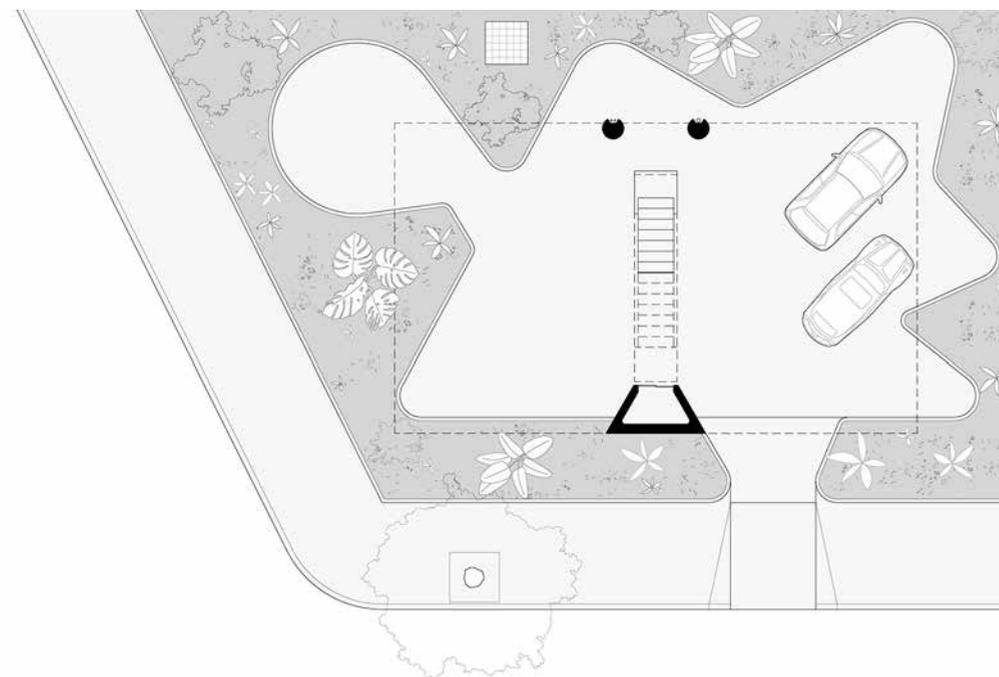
PLANTA BAJA. FUENTE: BEN-AVID
